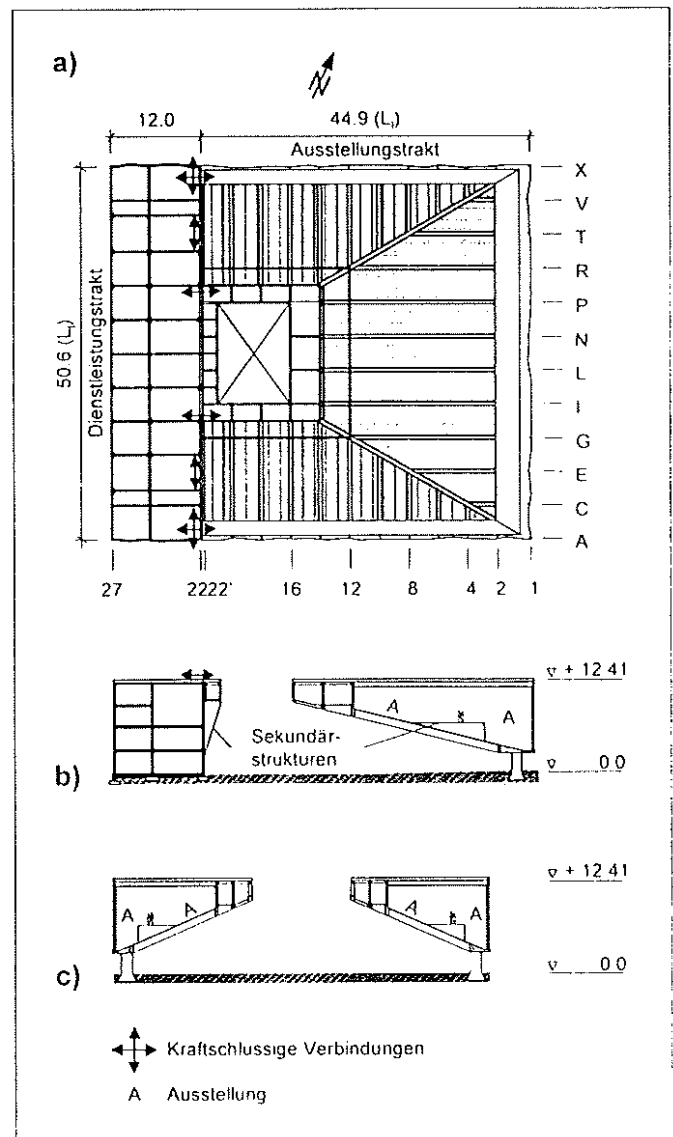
a) Grundriß der Haupttragstruktur, b) Längsschnitt, c) Querschnitt
